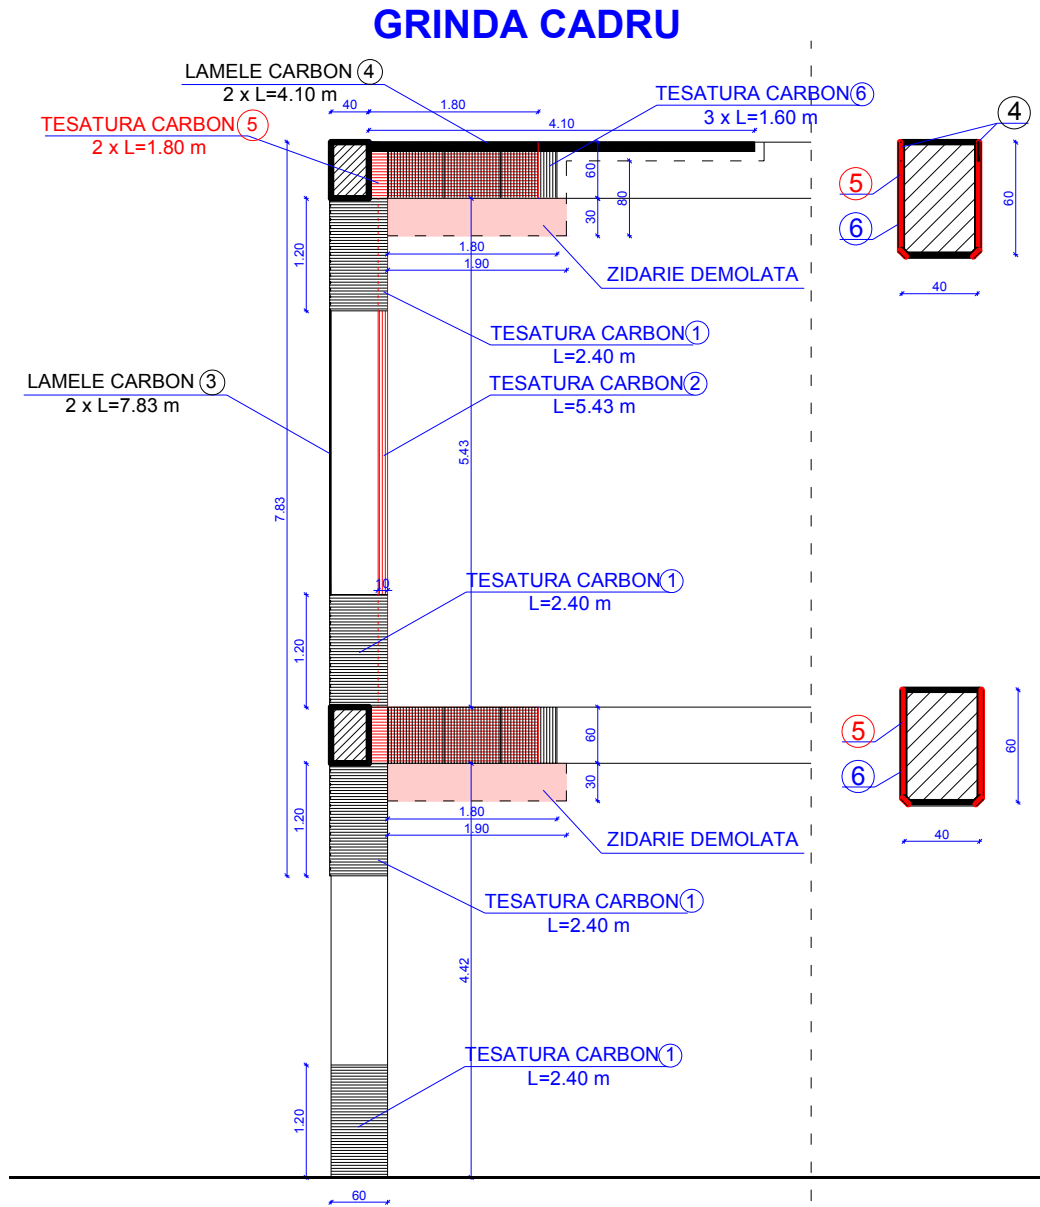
Schema de consolidare a cadrelor din beton armat
